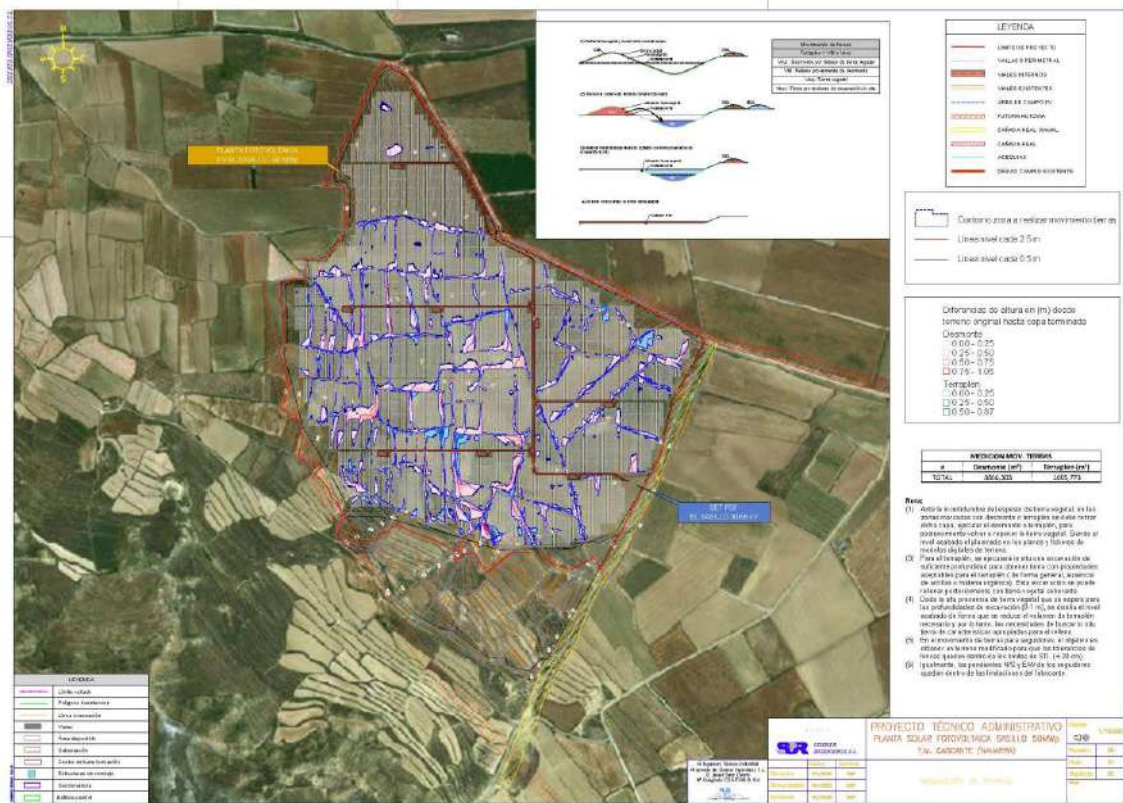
detalles de los movimientos de tierra sobre ortofoto para el conjunto de la planta fotovoltaica.
